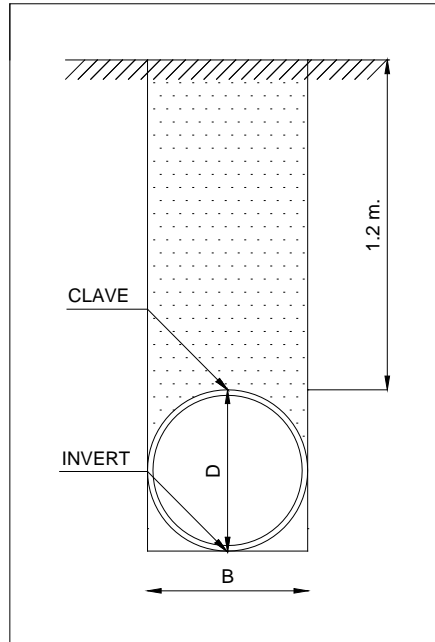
Corte de la zanja de Instalación del Pozo
